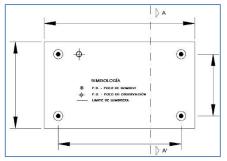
Planta esquemática del arreglo de pozos para el bombeo previo a la excavación de lumbreras.
